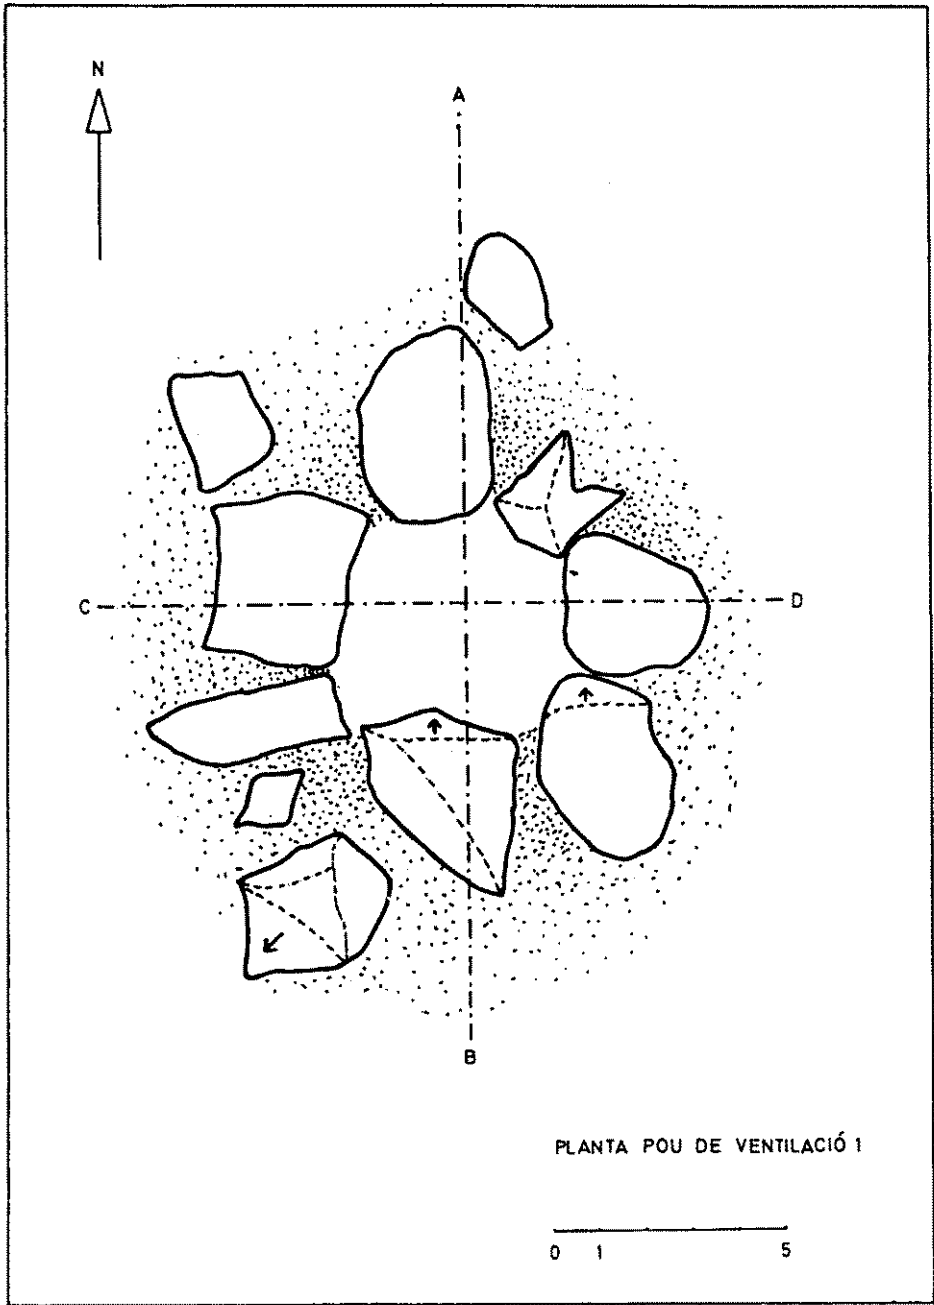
Planta del pou de ventilació núm. 1 (Olesa de Bonesvalls, Garraf).
